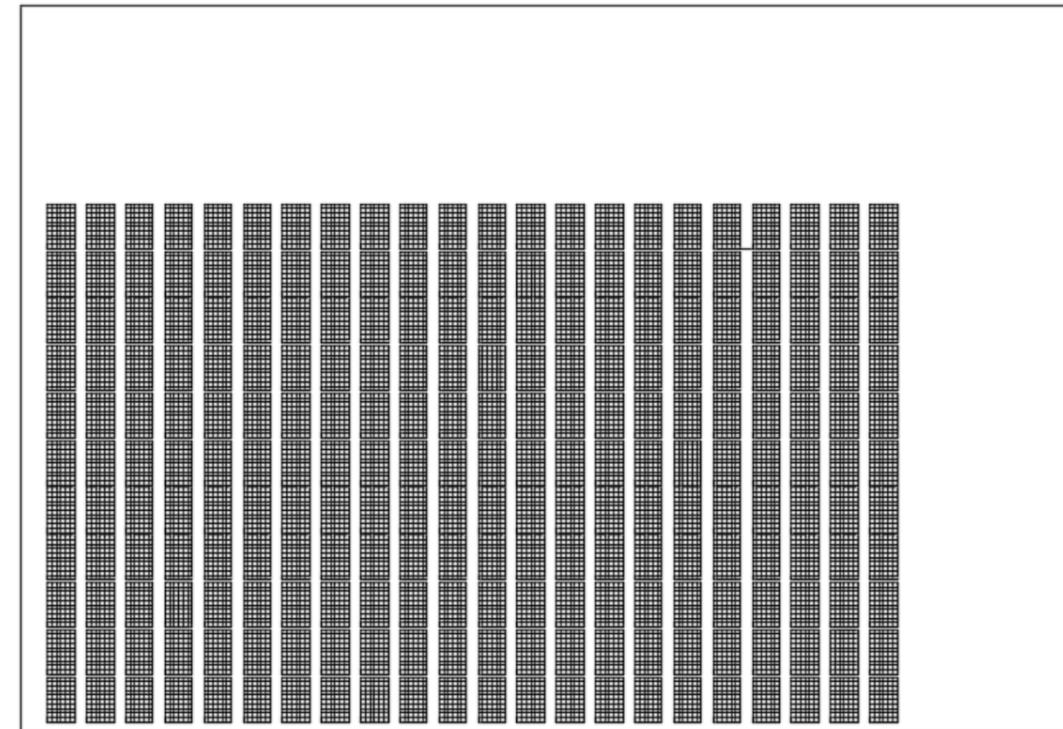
Planta techo nave industrial ocupado con 3/4 módulos.
